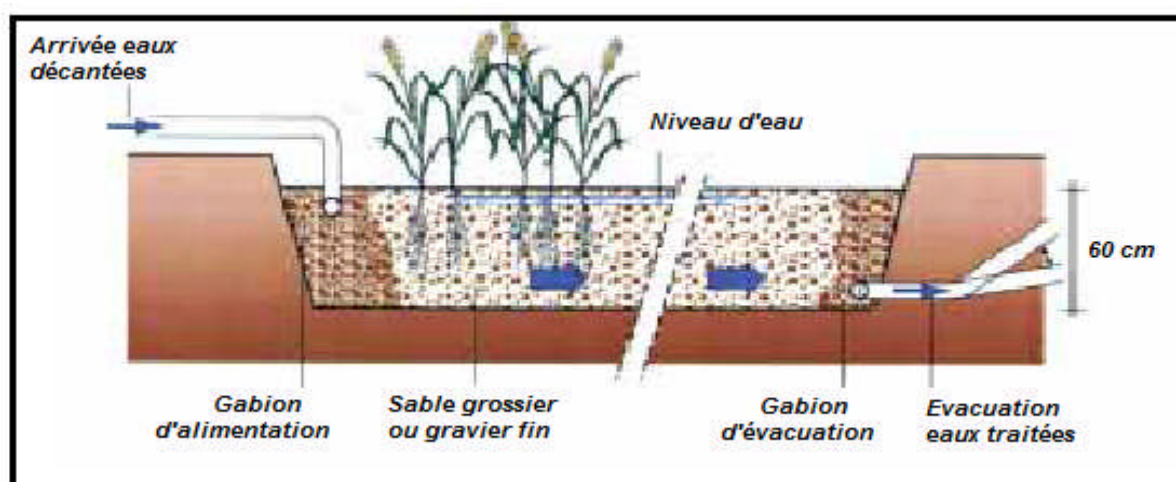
Coupe transversale d'un filtre planté à écoulement horizontal.
